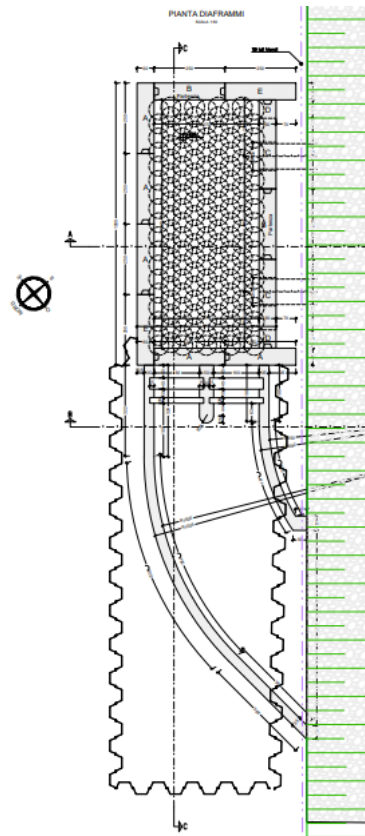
pianta del pozzo di spinta con indicazione palancole utilizzate
